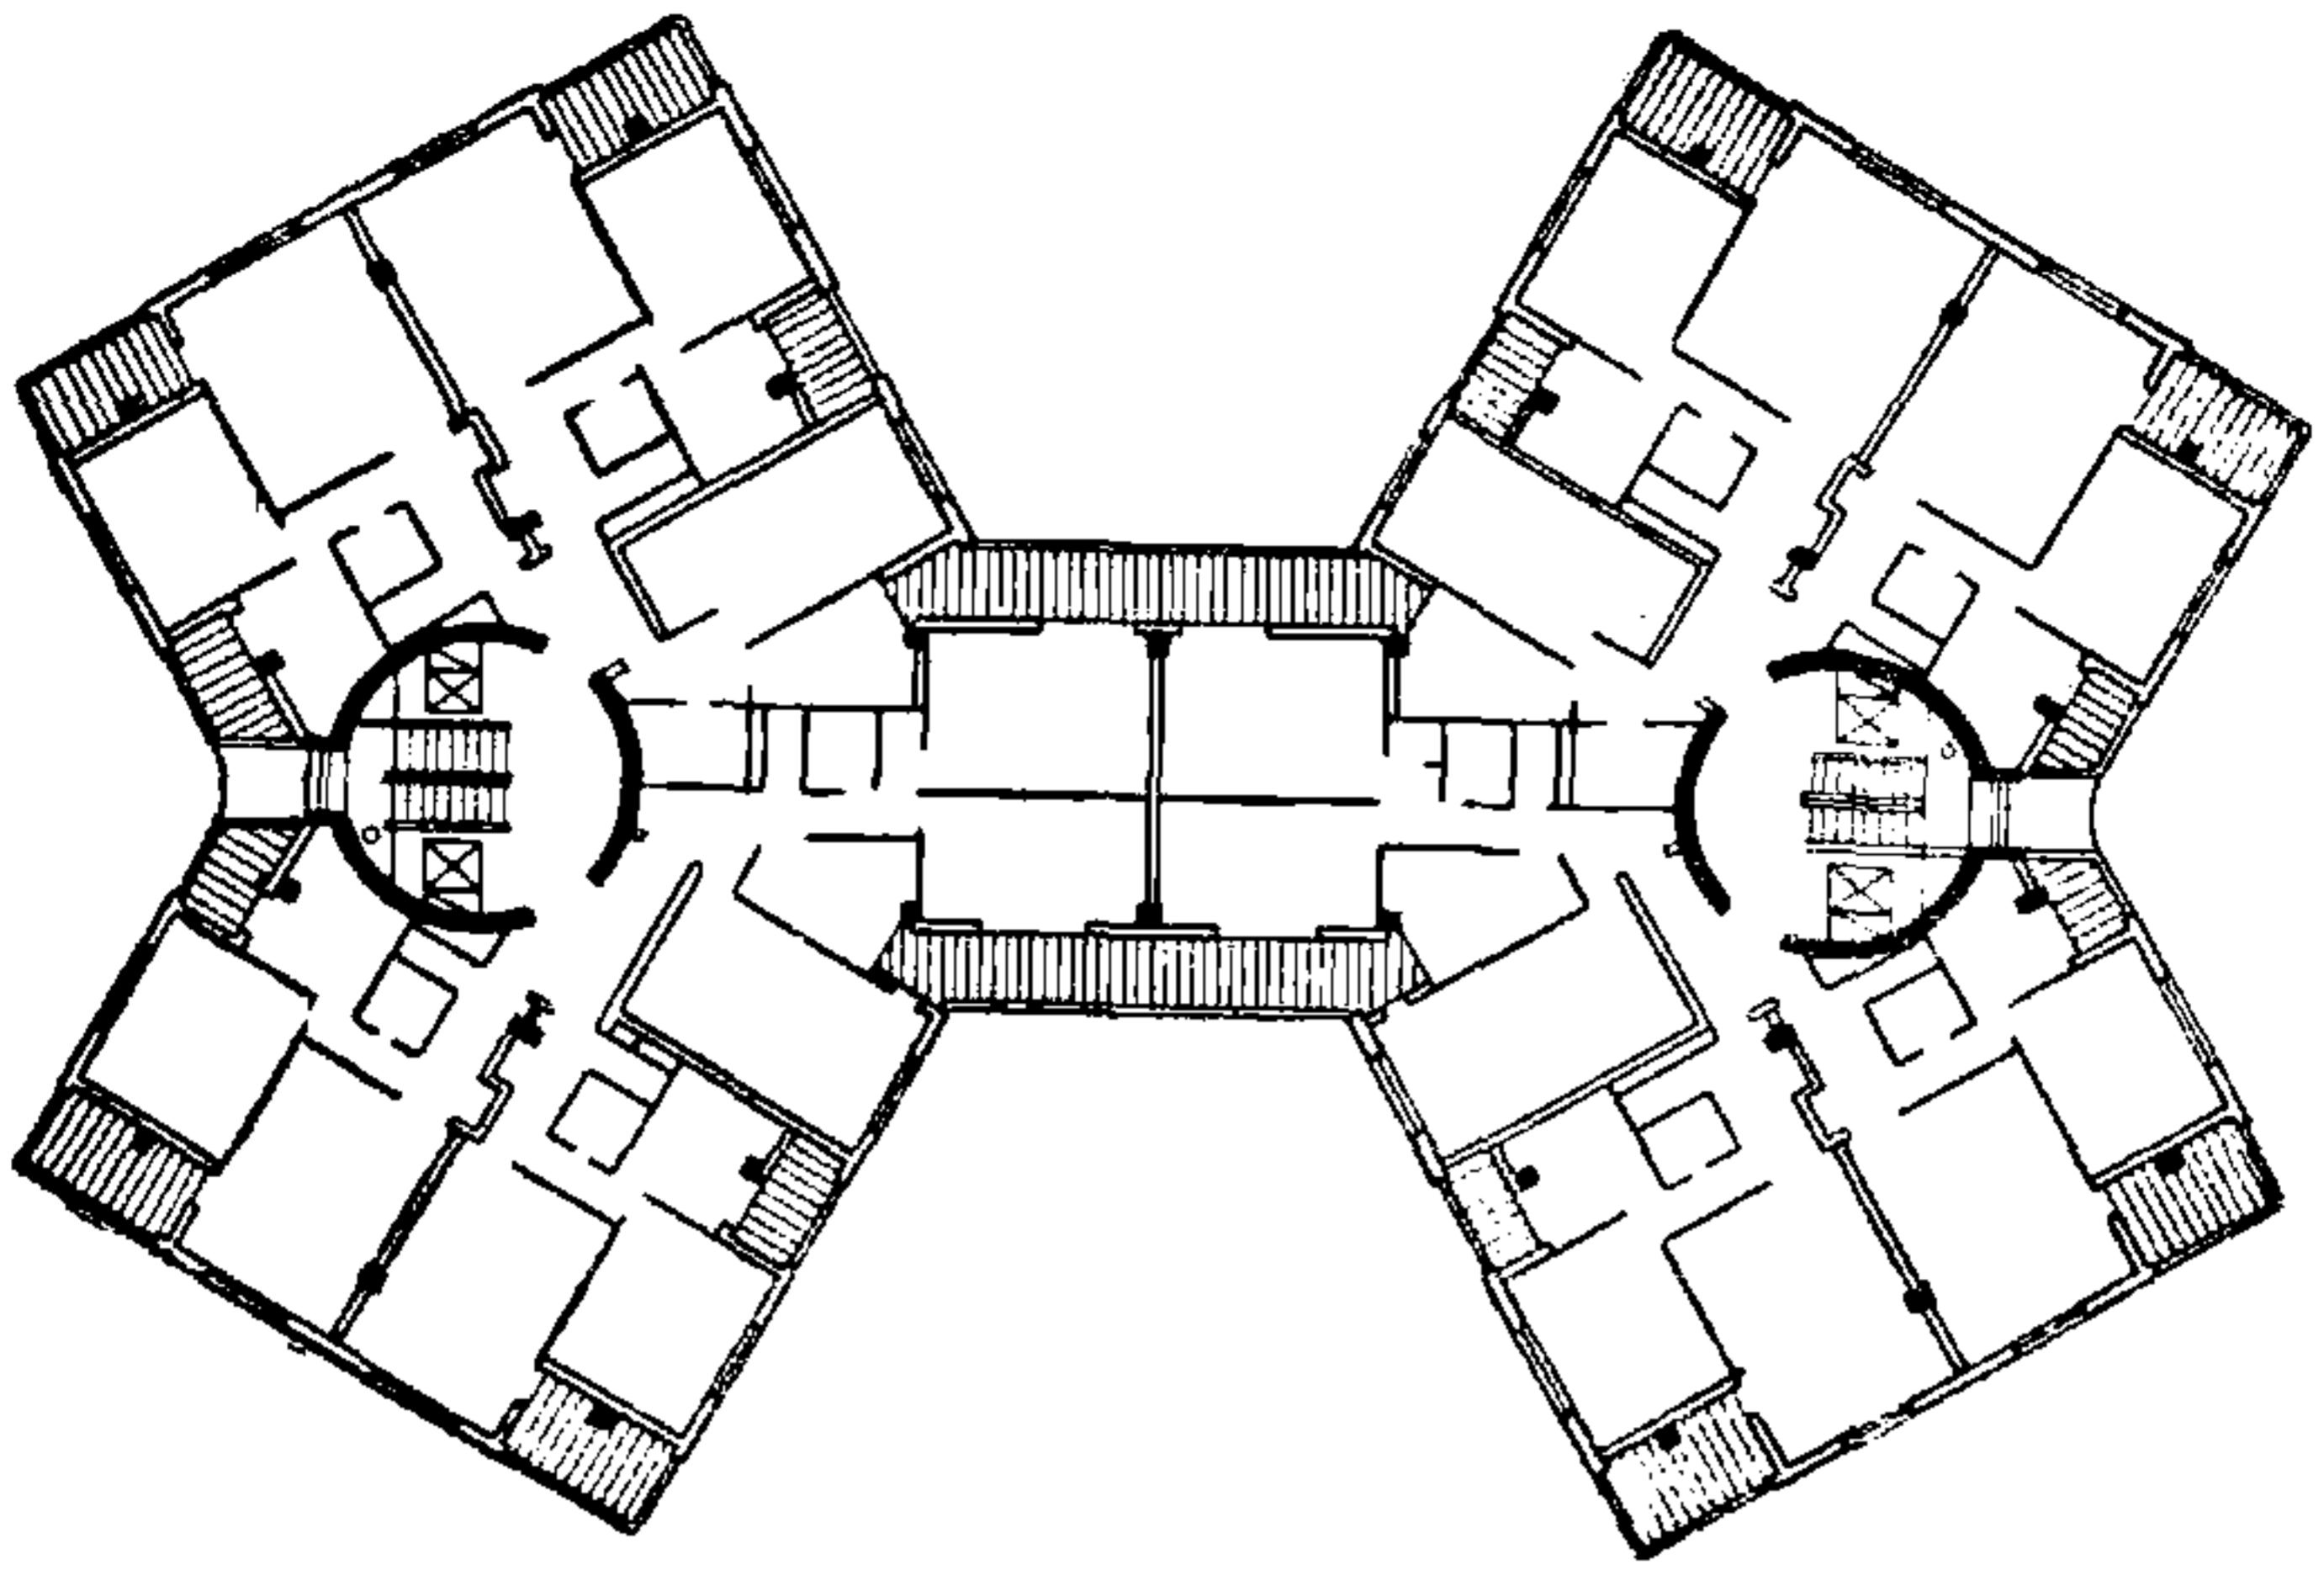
План типового этажа 12-этажного жилого дома типа «спаренный трилистник» (СПЭКБ АрмССР)
